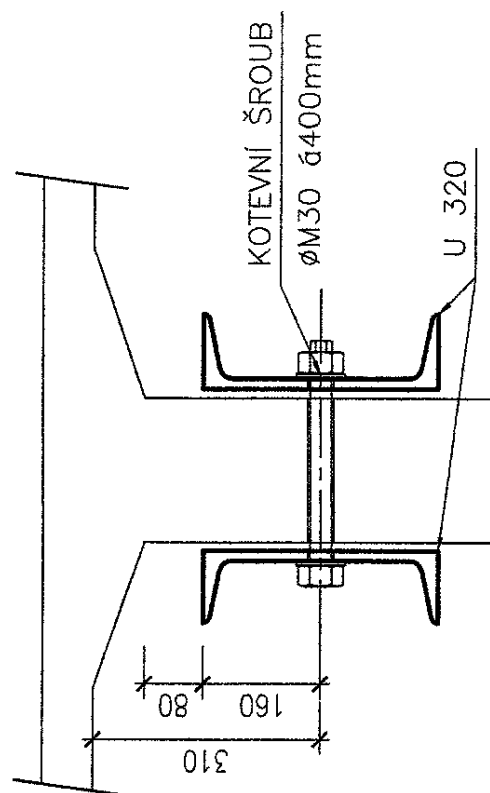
PROŠROUBOVÁNÍ m 1:10
